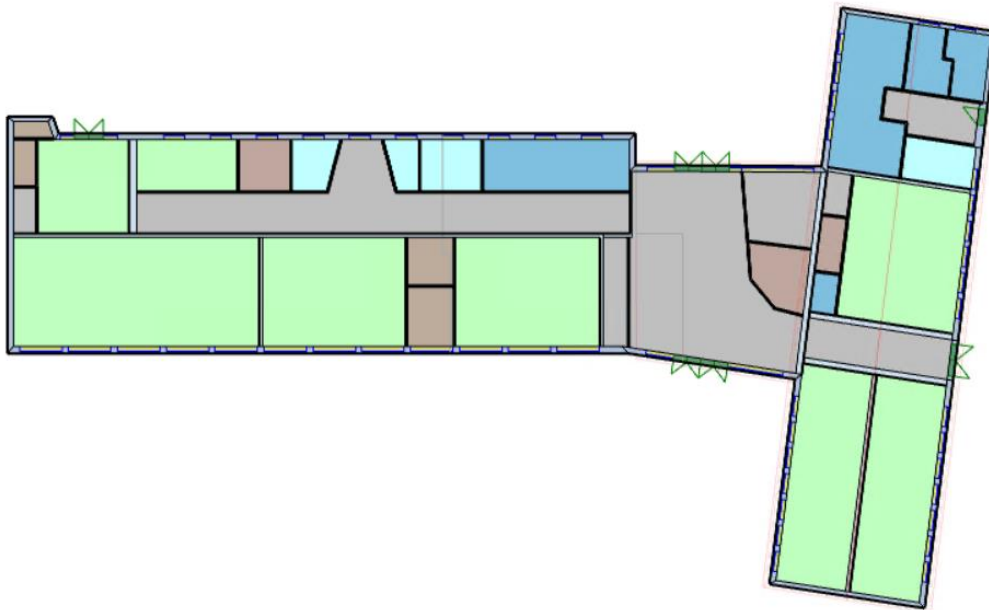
Grundriss Erdgeschoss, zoniert
